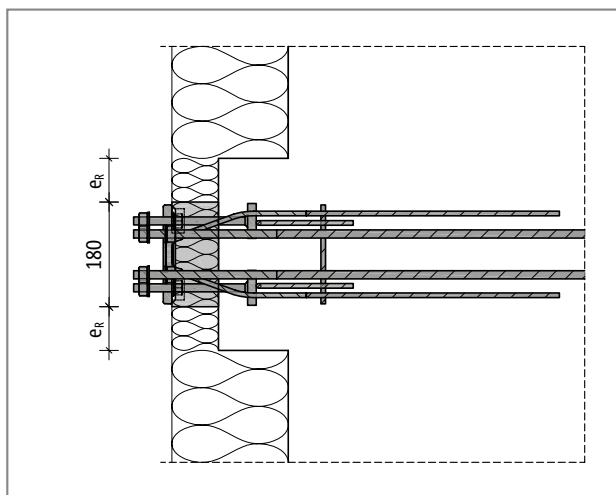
Schöck Isokorb® T tipo SKP: distanze tra i bordi
